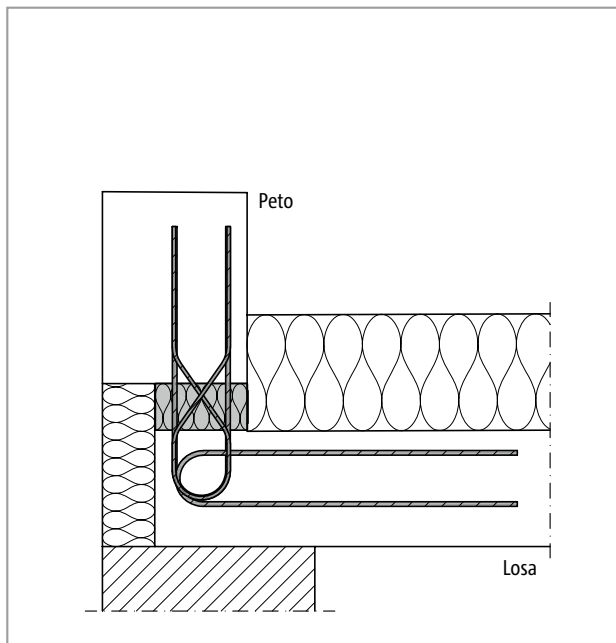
Schöck Isokorb® T tipo A: Conexión de un peto (T tipo A-MM1)
